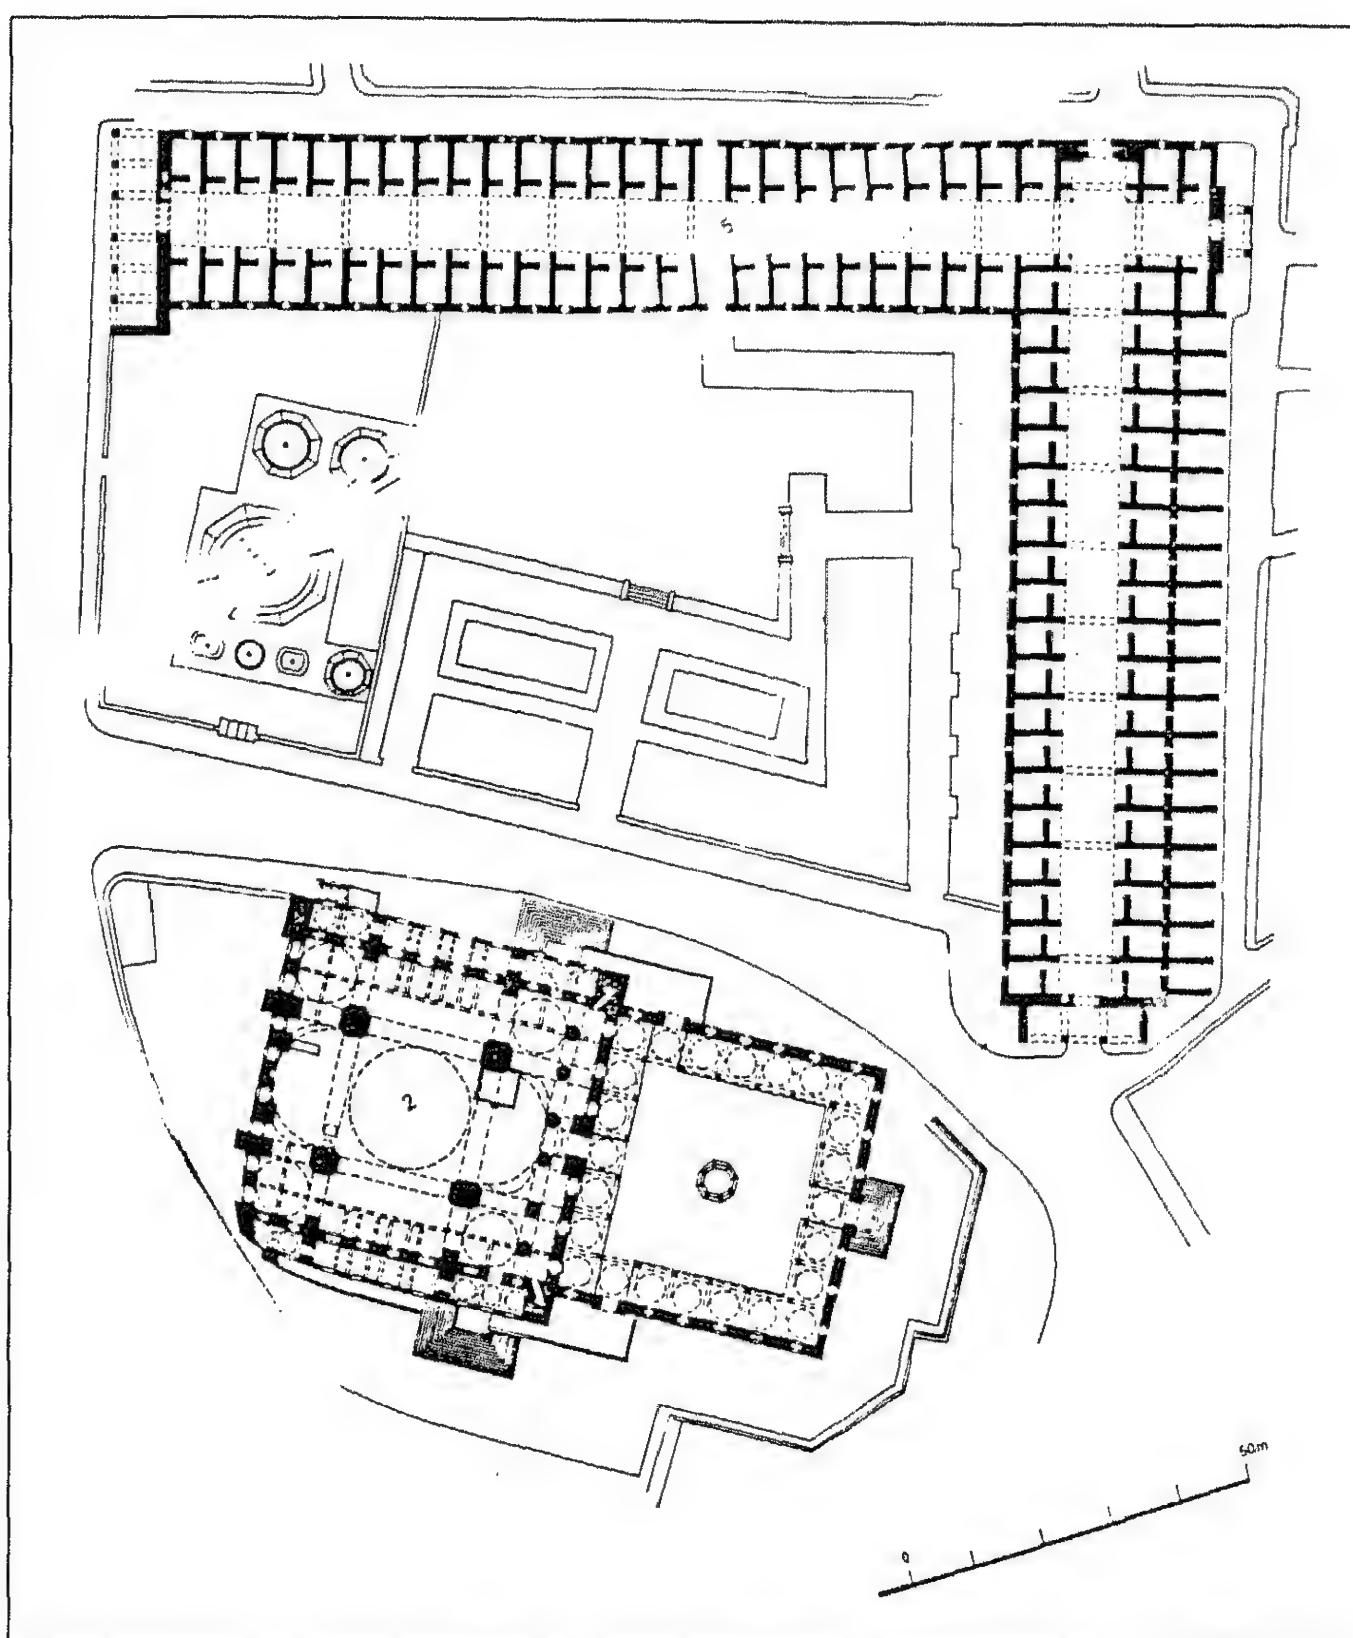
مسقط أفقي لمجمع السلیمانیة فی إستانبول (عن : كوران) .
